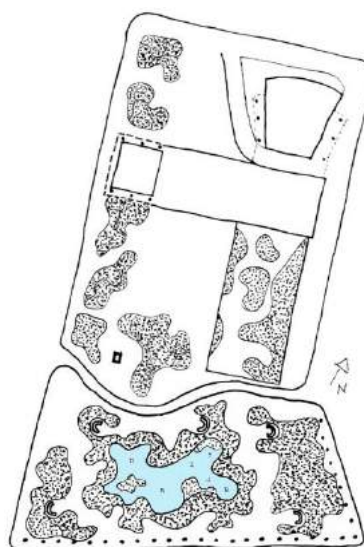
Planta baixa esquemática de todo o conjunto no térreo do MES, com a proposta para o terreno adjacente. Fonte: Desenho da Autora
